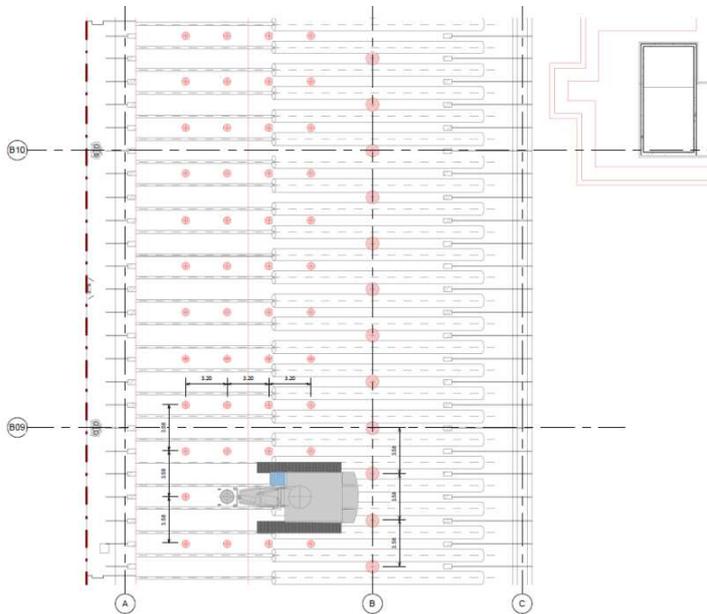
Planimetria con indicazione della posizione dei pali trivellati Ø1000 e Ø600
